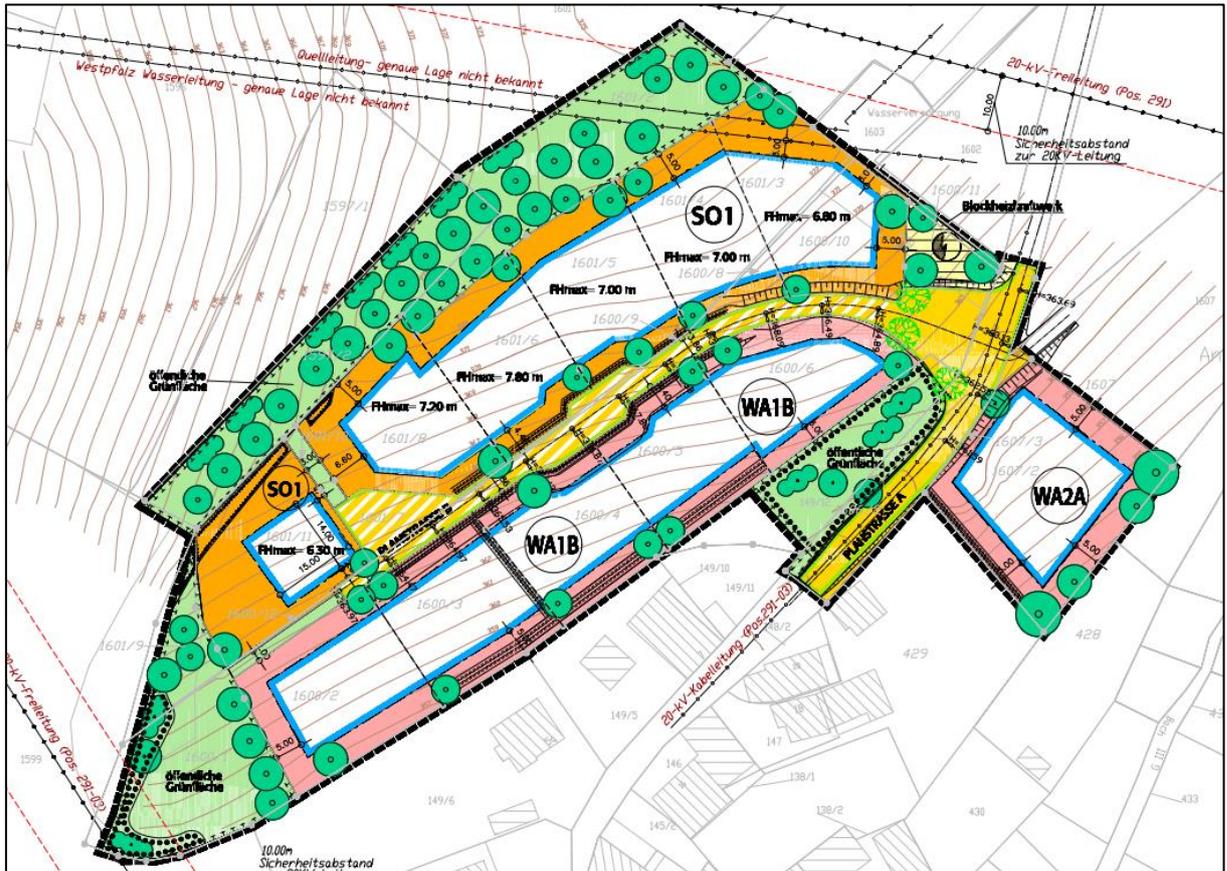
Bestandsbebauungsplan 2003 (Ausschnitt)
